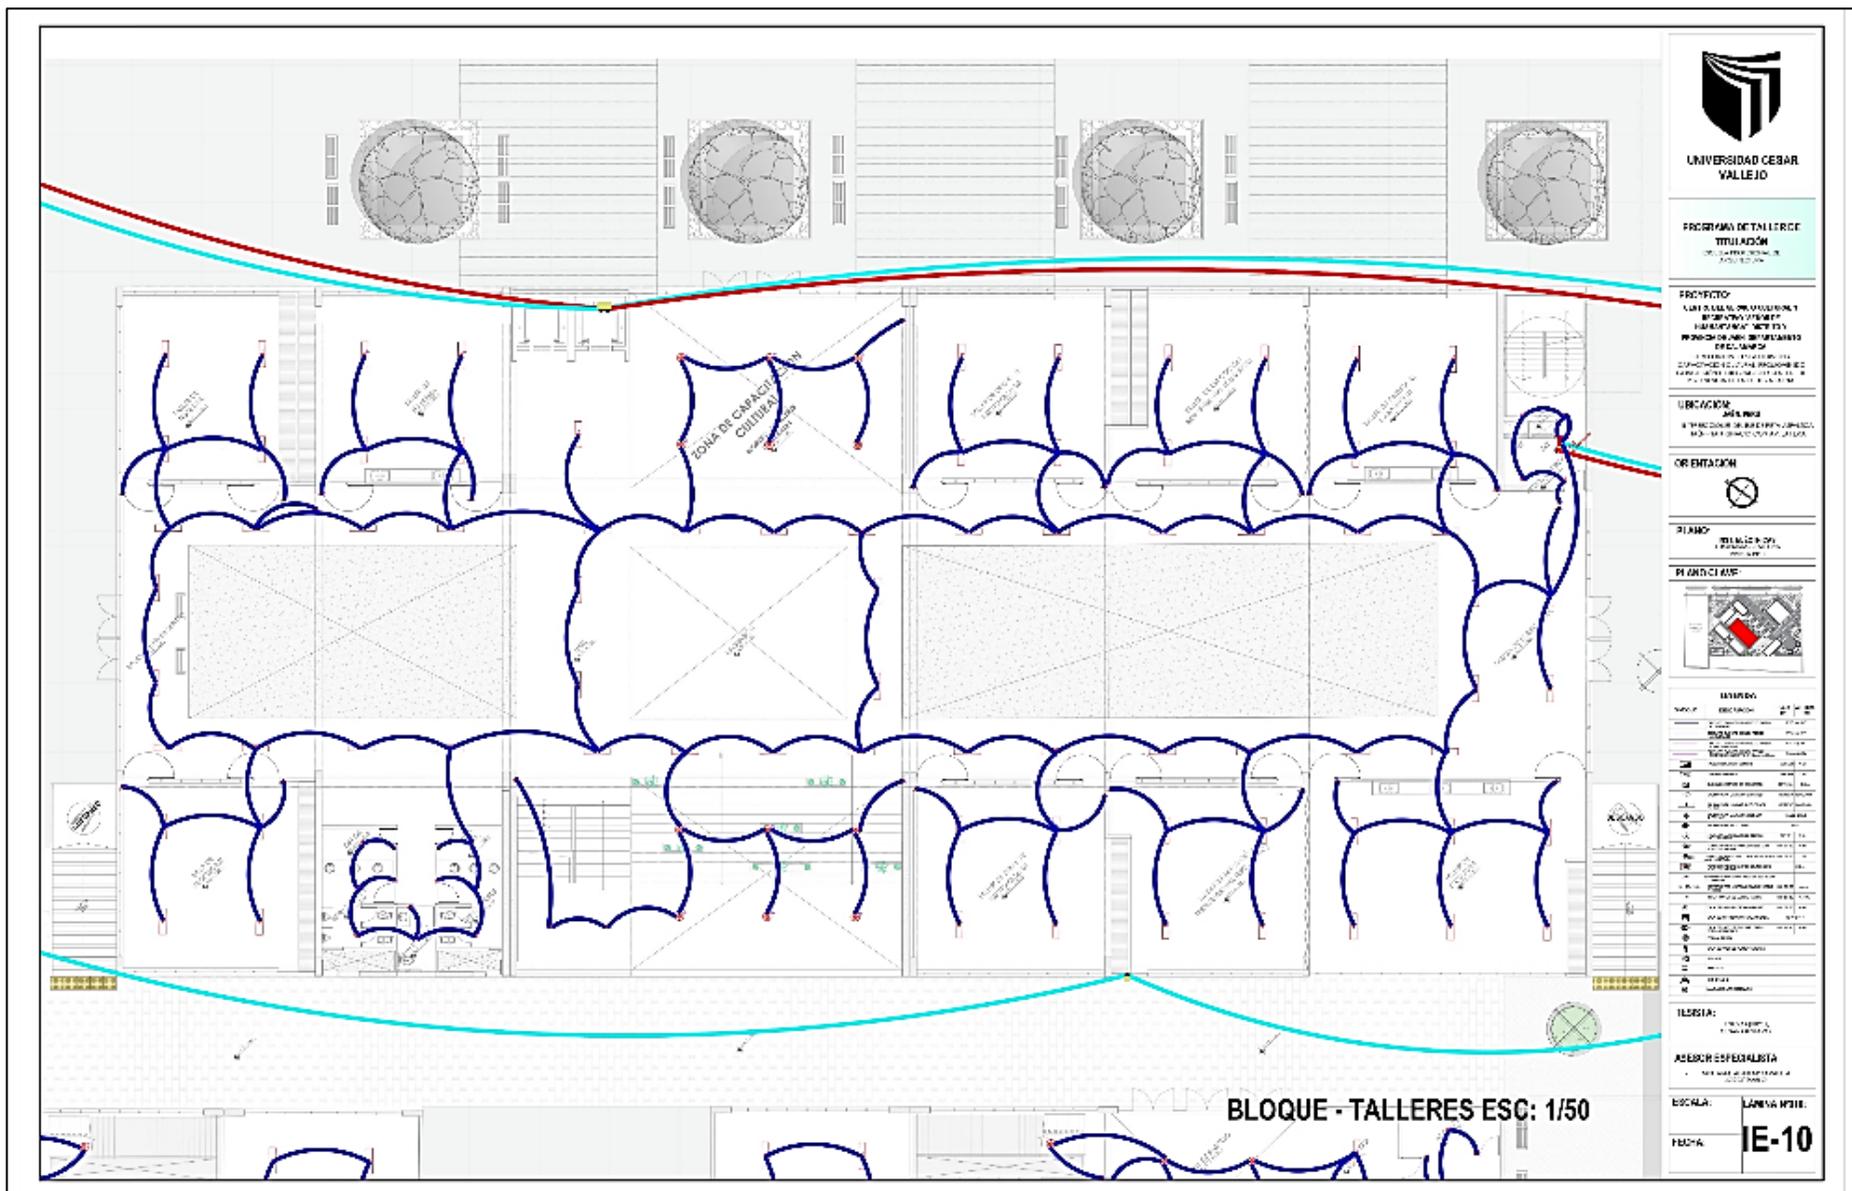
Planta de distribución de alumbrado 1er nivel – talleres
